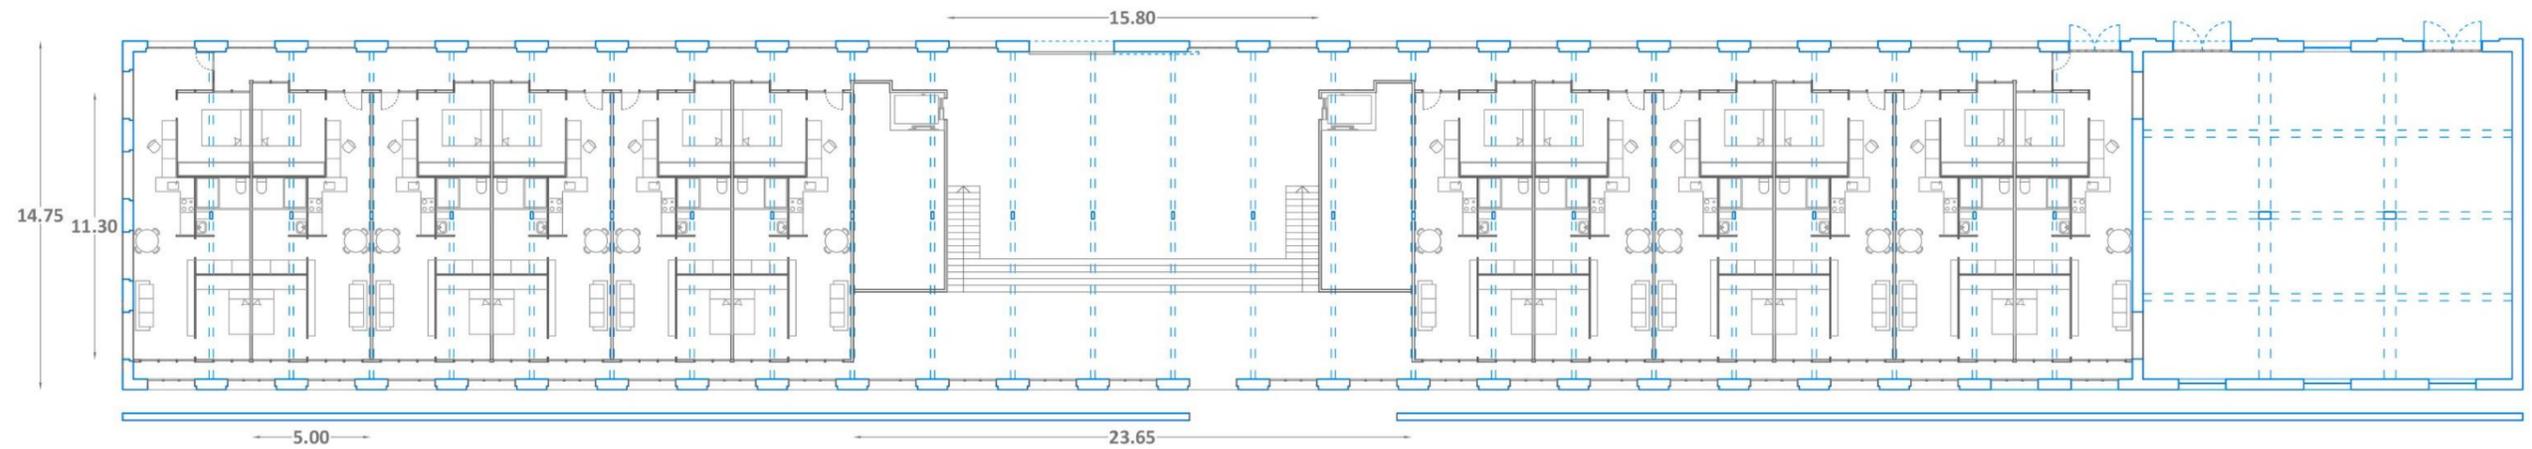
PLANO 1/300. Planta baixa intervenció nave G fàbrica Fabra i Coats.
